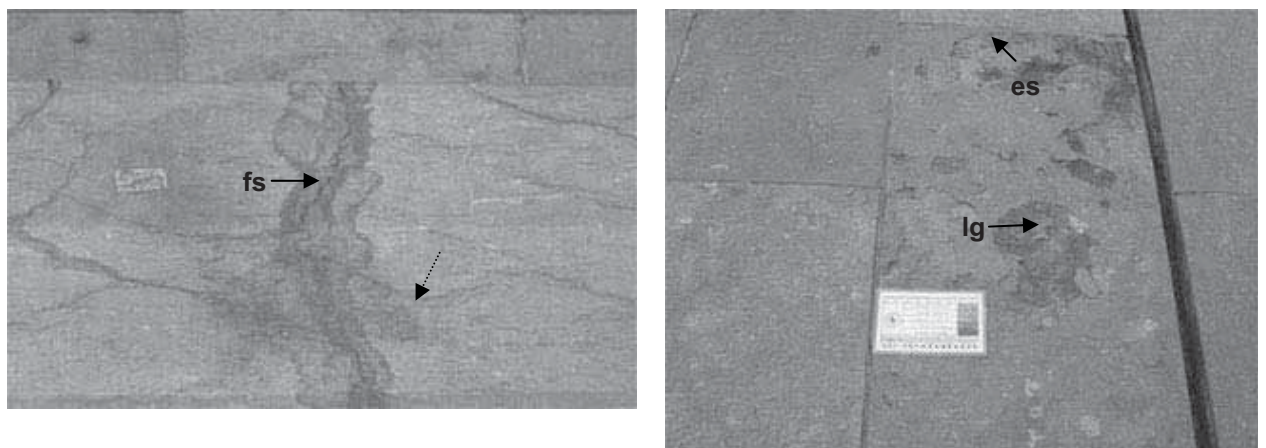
A) Fissuração (fs) e acréscimo da fissuração (···▶) em chapas de calcário usadas em escadaria. B) Lascagem (lg) e esfoliação (es) em pisos exteriores. Centro Administrativo La Alpujarra.
